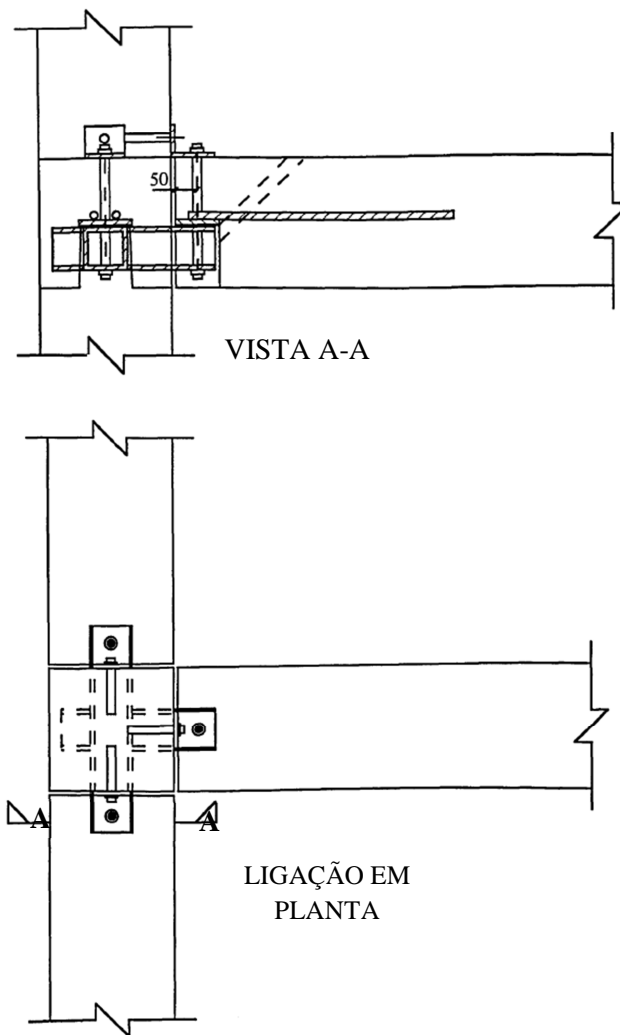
Vista em planta e elevação da ligação com perfil de seção vazada parafusada [GORGUN (1997)].
